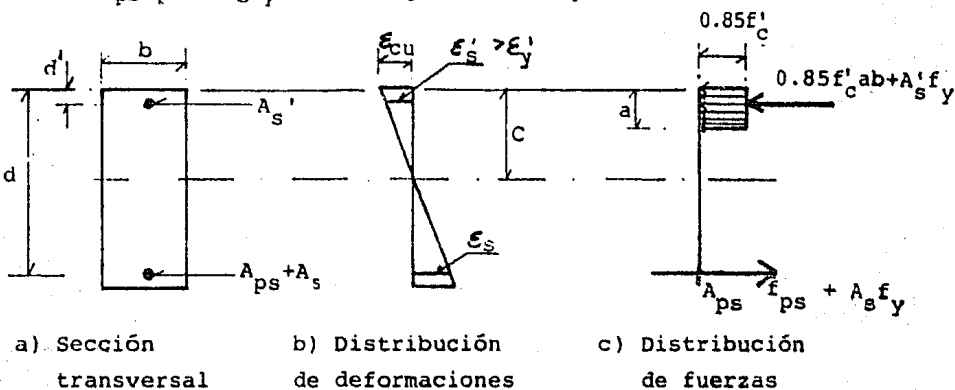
Viga rectangular con refuerzo en compresión.
